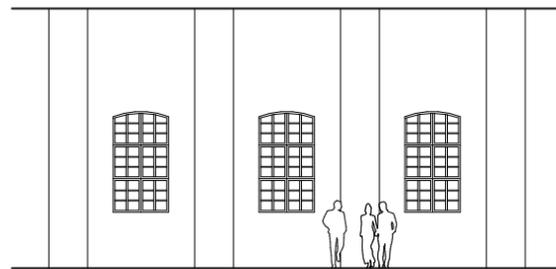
Haupthalle mit eingestürztem Dachstuhl
